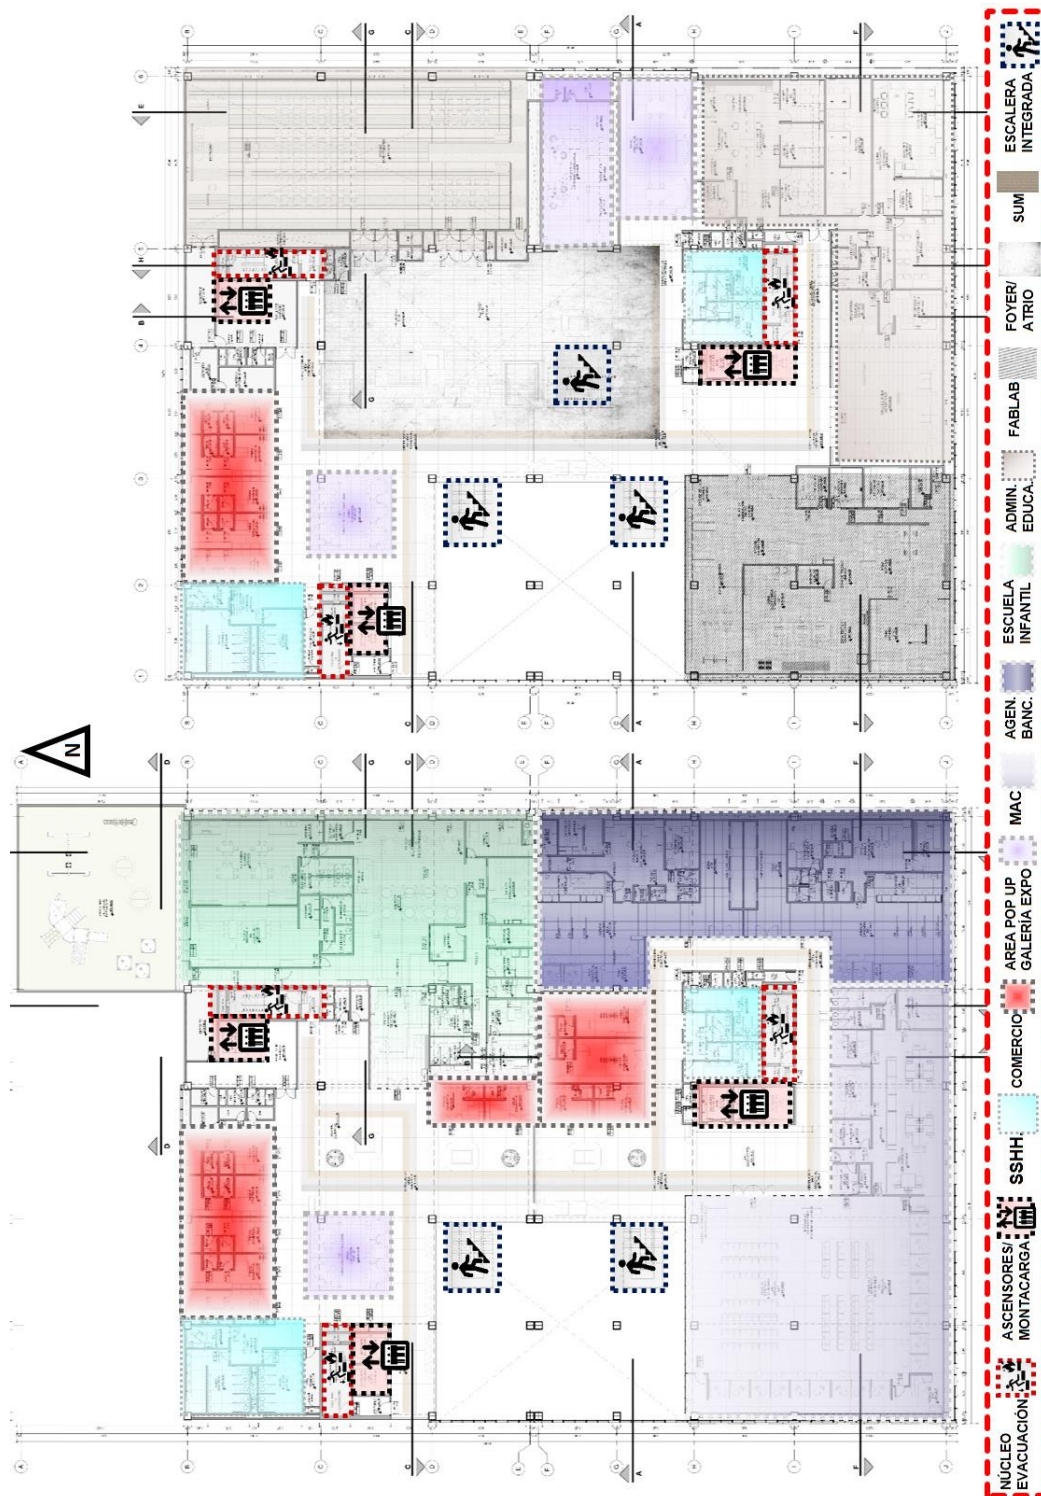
Vistas de las plantas generales del cuarto piso (inferior) y del quinto piso (superior).
